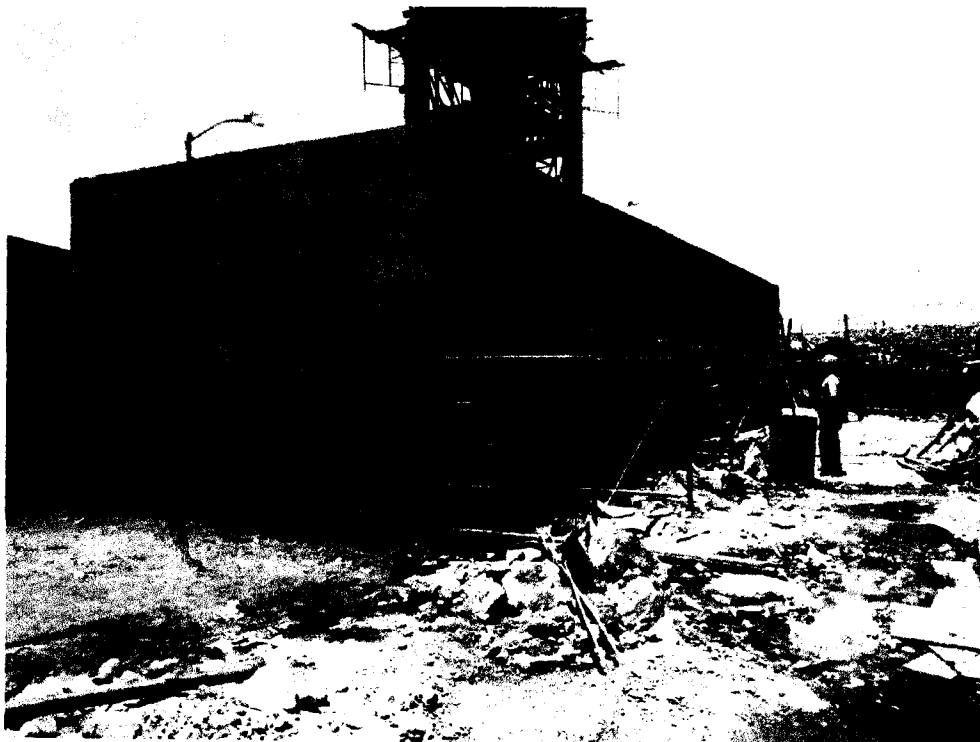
tarrajeo de muros, vigas, columnas y cielos rasos del área de talleres.
